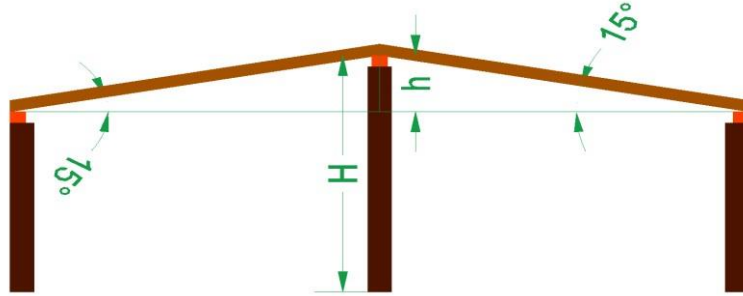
ángulo de inclinación para determinar la altura de la columna central; Fuente: (Silva & Valencia, 2023)
